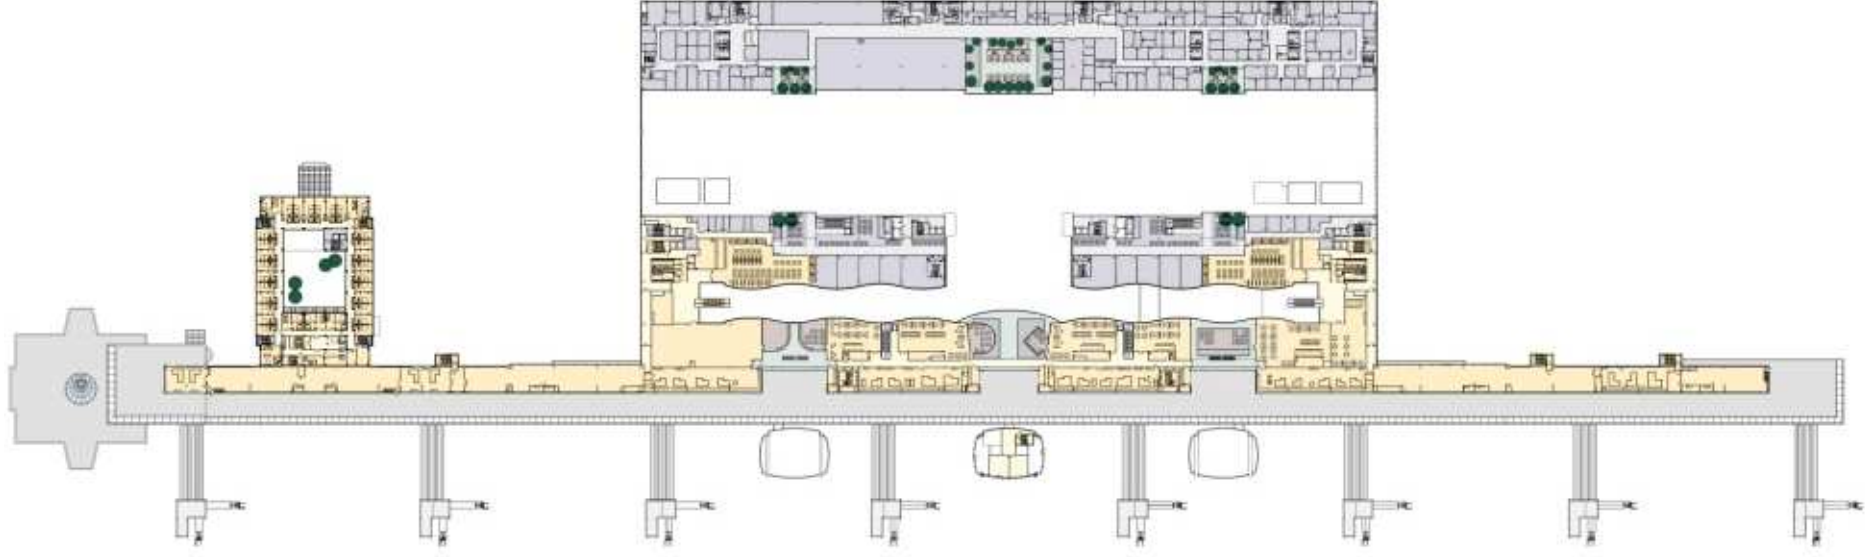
Sabiha Gökçen Havalimanı 1.Bodrum Kat Planı²³⁸
